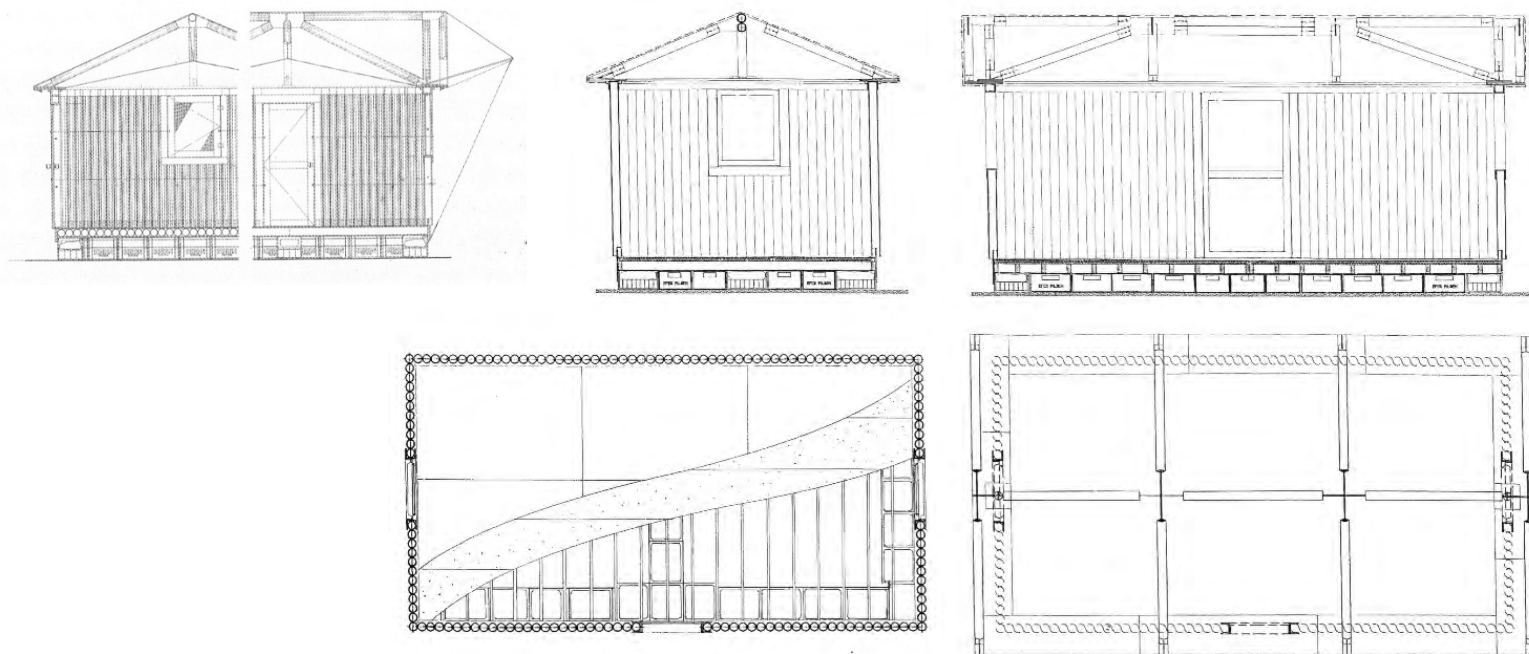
Planta, alzados y sección de la Casa de troncos de papel de Turquía
